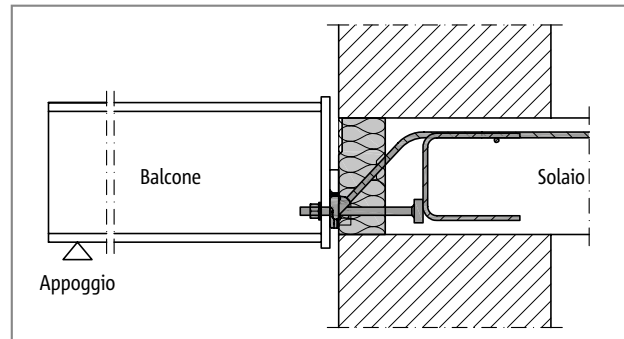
Schöck Isokorb® T tipo SQP: raccordo alla soletta in calcestruzzo armato; costruzione monolitica della parete
